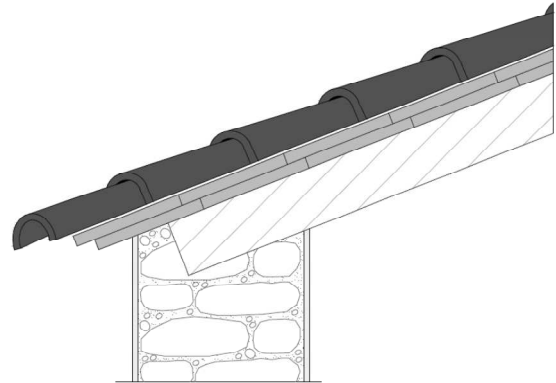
Fachada-Cubierta. Zona este. Estado original.
